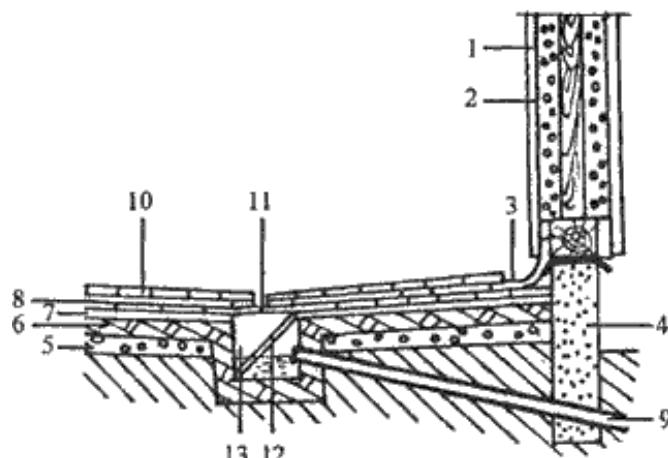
Бетонный пол: 1 — внутренняя обшивка каркасной стены; 2 — пароизоляция; 3 — гидроизоляция; 4 — фундамент; 5 — щебеночно-гравийная подсыпка; 6 — бетон с теплоизолирующим наполнителем; 7 — цементная стяжка; 8 — покрытие из керамических плиток; 9 — водосливная труба; 10 — деревянная решетка; 11 — водосточная решетка; 12 — гидрозатвор; 13 — приямок.
